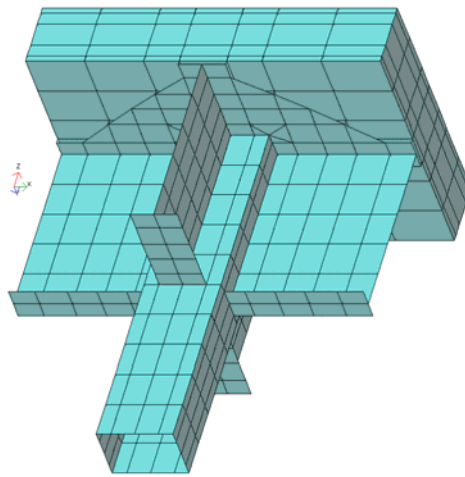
Узел примыкания ригелей и плиты перекрытия к колонне в модели 2
